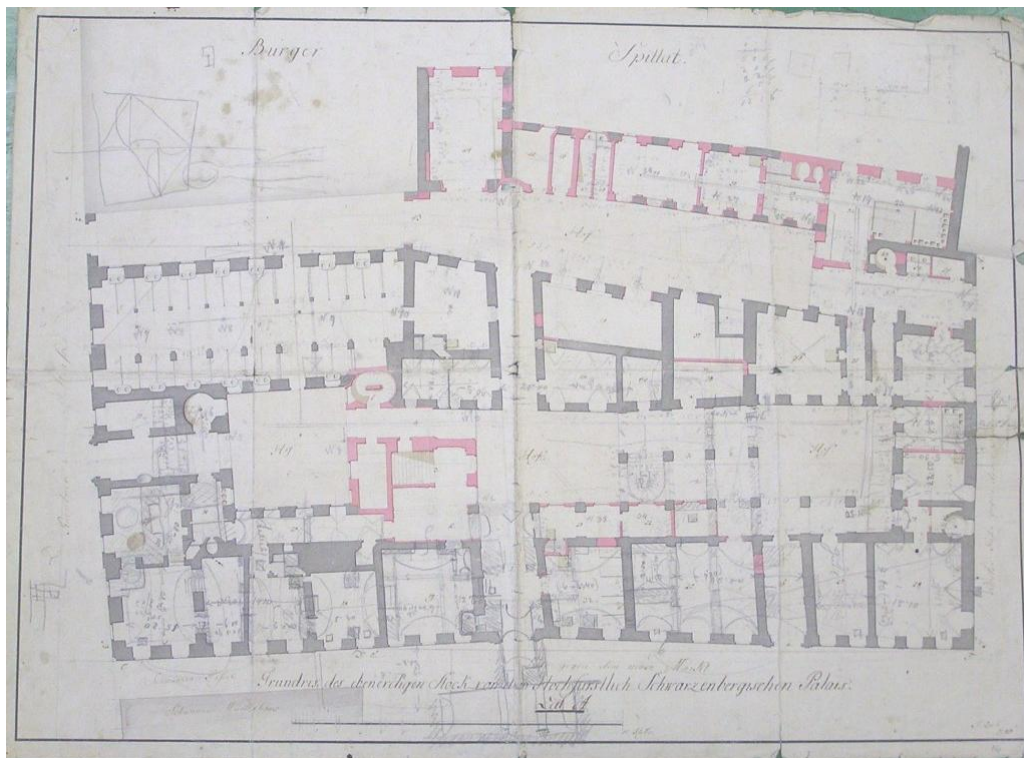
Ehemaliges Stadtpalais Schwarzenberg Grundriss Erdgeschoss Litt. A,
